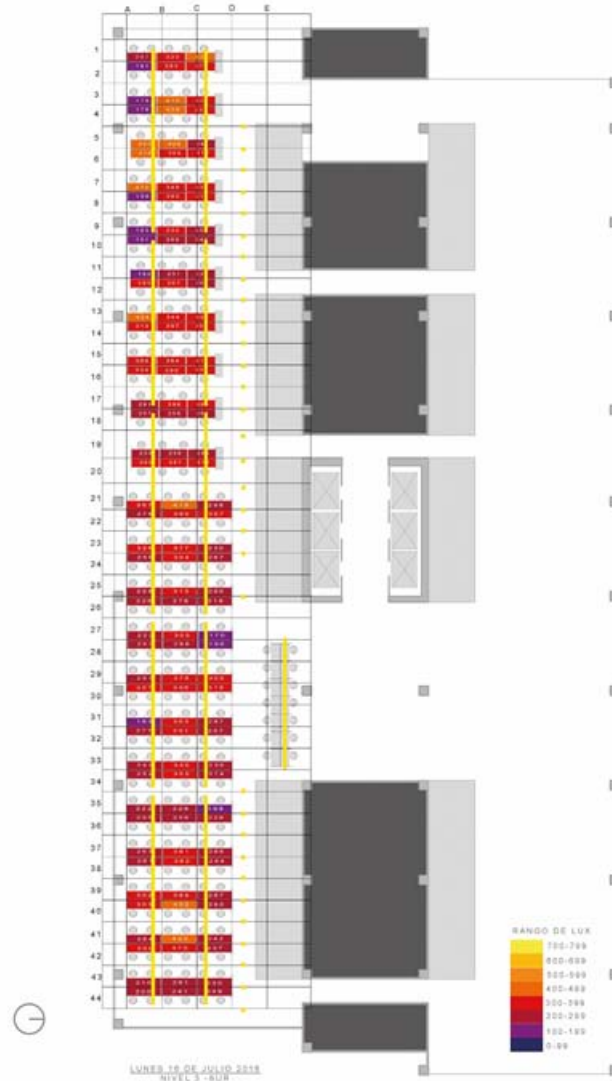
Planta arquitectónica de nivel tres, niveles de iluminancia de 16 de julio
